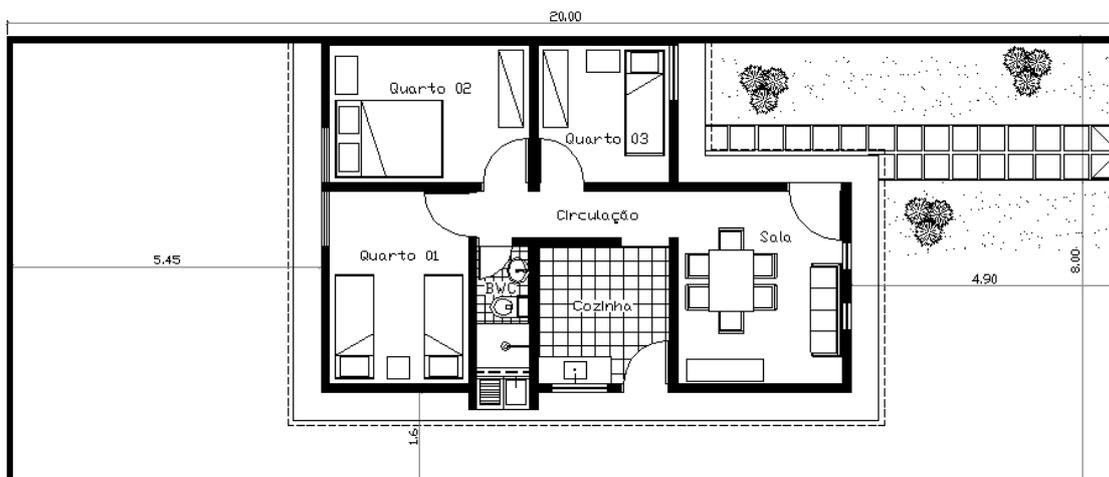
Planta baixa (com mobília proposta) de unidade original do Conjunto Osman Loureiro.
